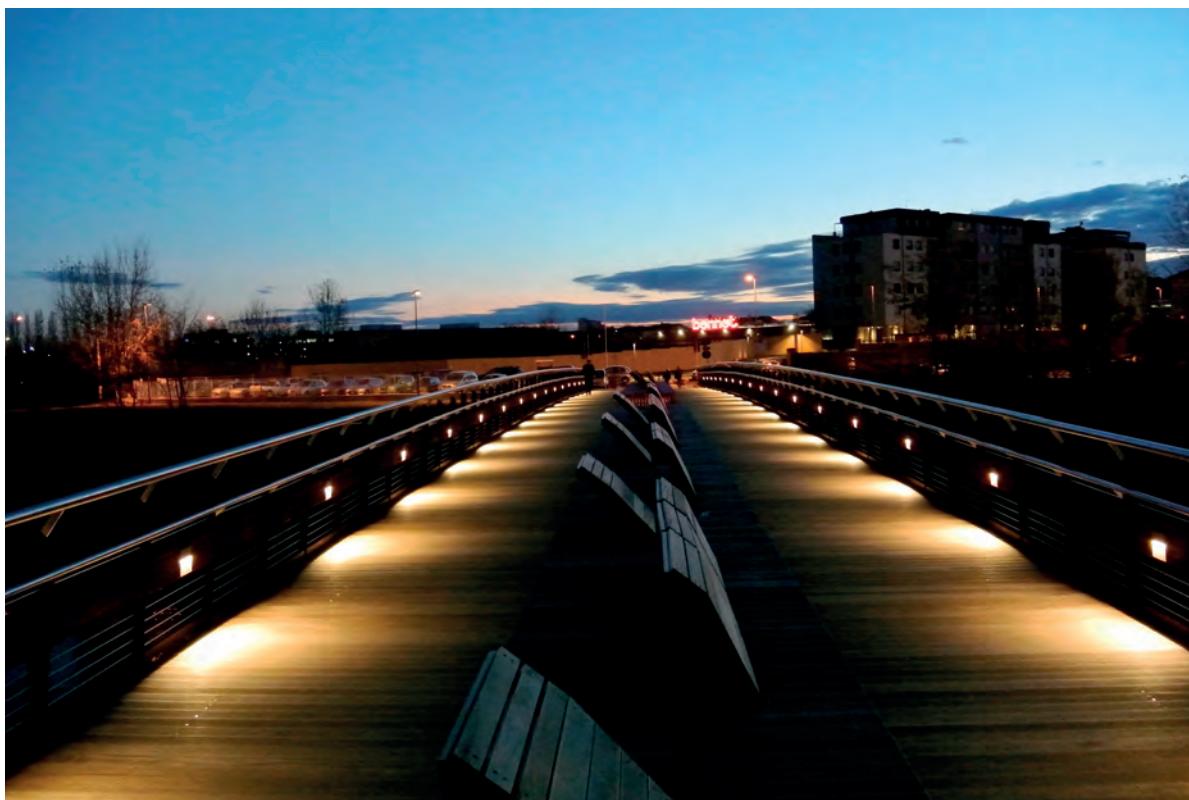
Vista passerella dal piano di calpestio con l'imbrunire a fare da cornice
